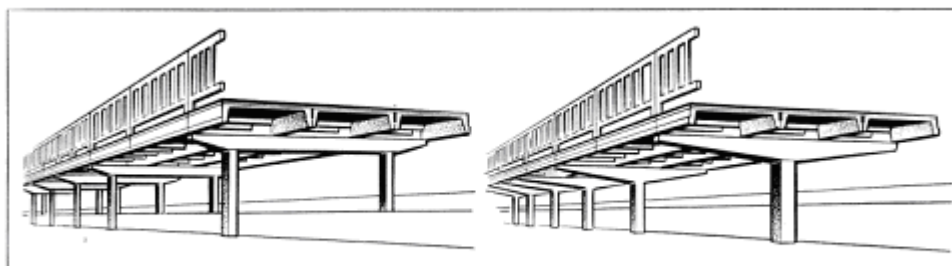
Высокие пассажирские платформы из железобетонных конструкций
